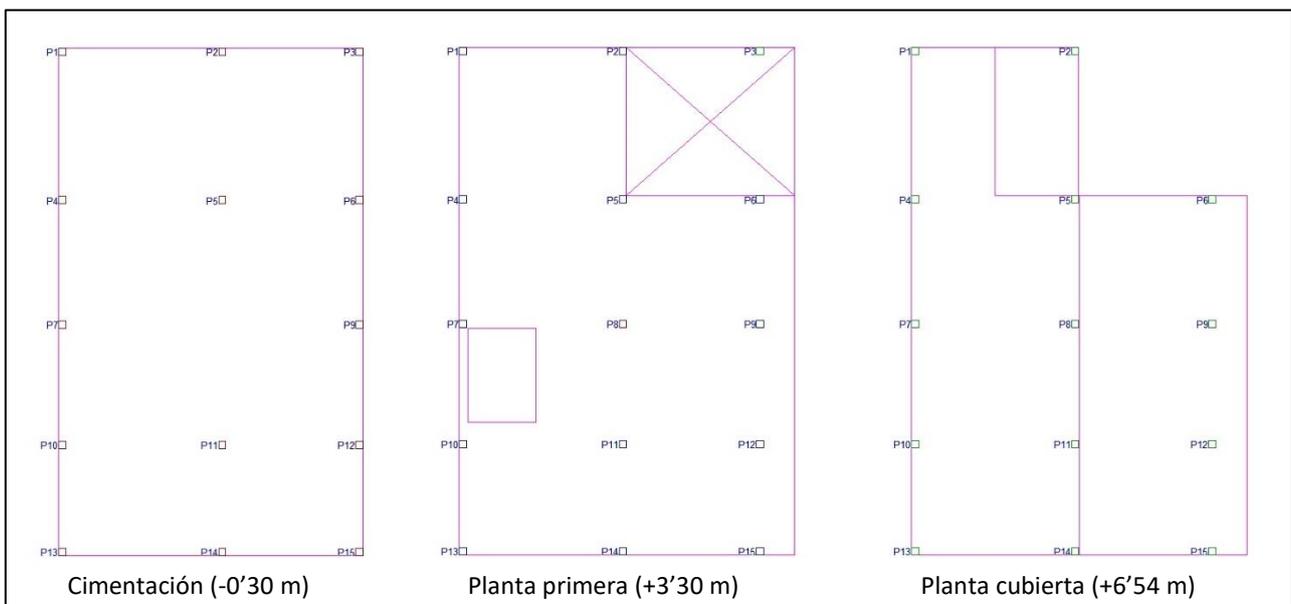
21. Recorte de pantalla, Vistas plantas importadas en Cypecad
